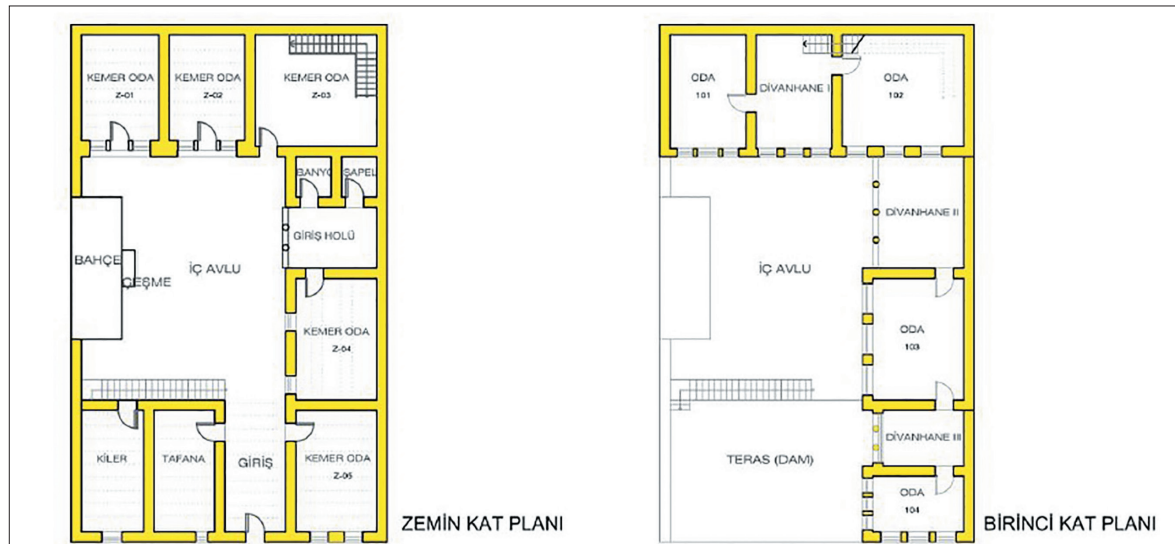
İç Sofalı Konut Planı / *Inner Hall House Plan* (Kent Tasarım Arşivinden)
